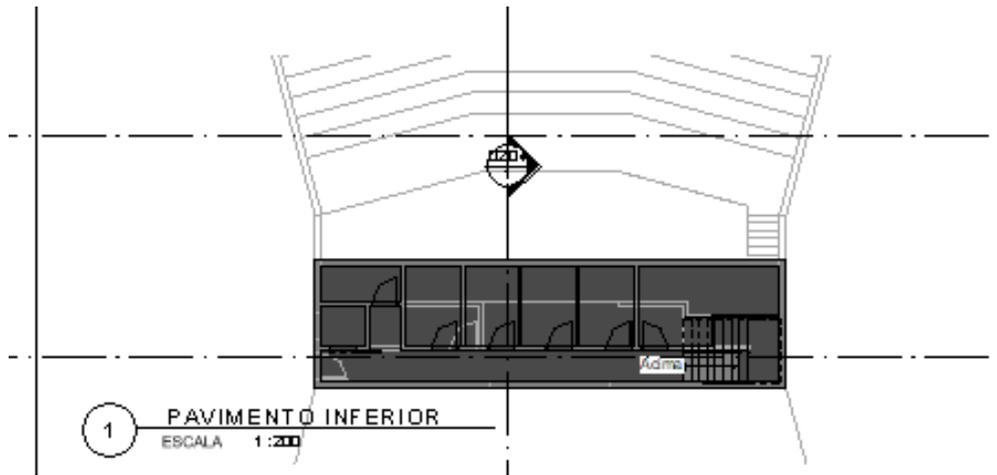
Estudo 2 – Auditório no pavimento inferior. Fonte: O Autor, 2018.
